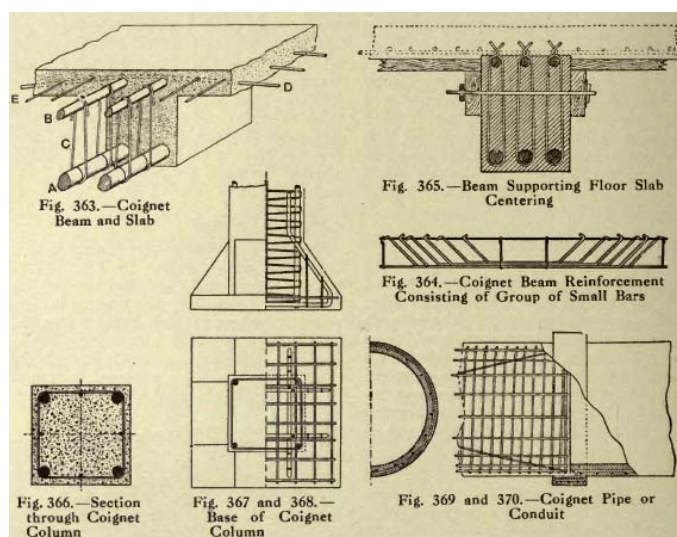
Detalhes de vários elementos estruturais do sistema construtivo em betão armado desenvolvido por Edmond Coignet, adaptado de (Jones, 1913).
